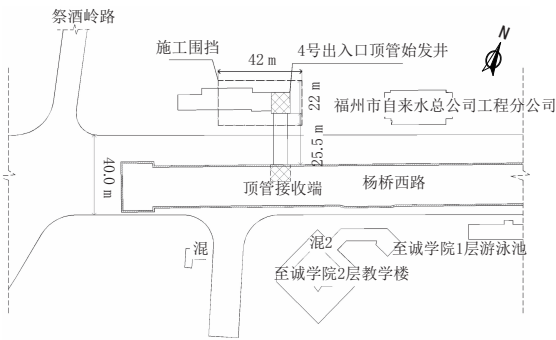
凤凰池站4号出入口过街通道顶管施工占地平面图
